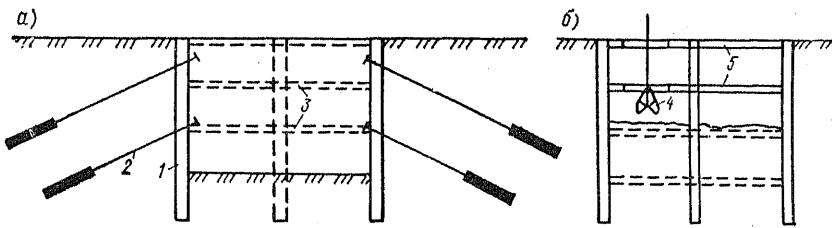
Устройство крепления стен котлованов методом «стена в грунте»
